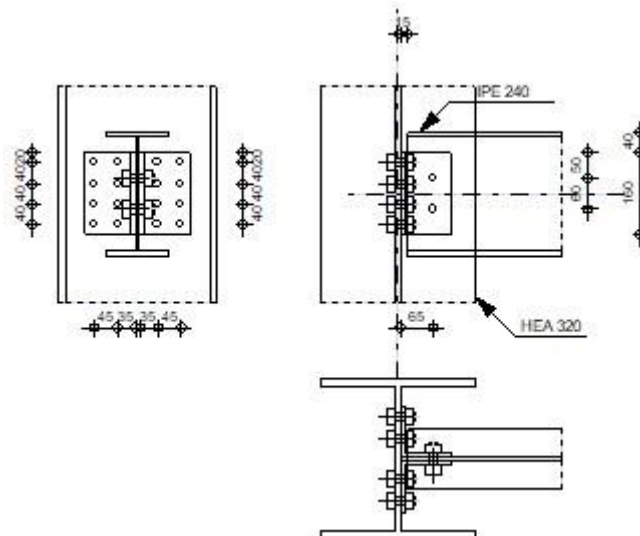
résultat de l'assemblage Poteau poutre secondaire .
